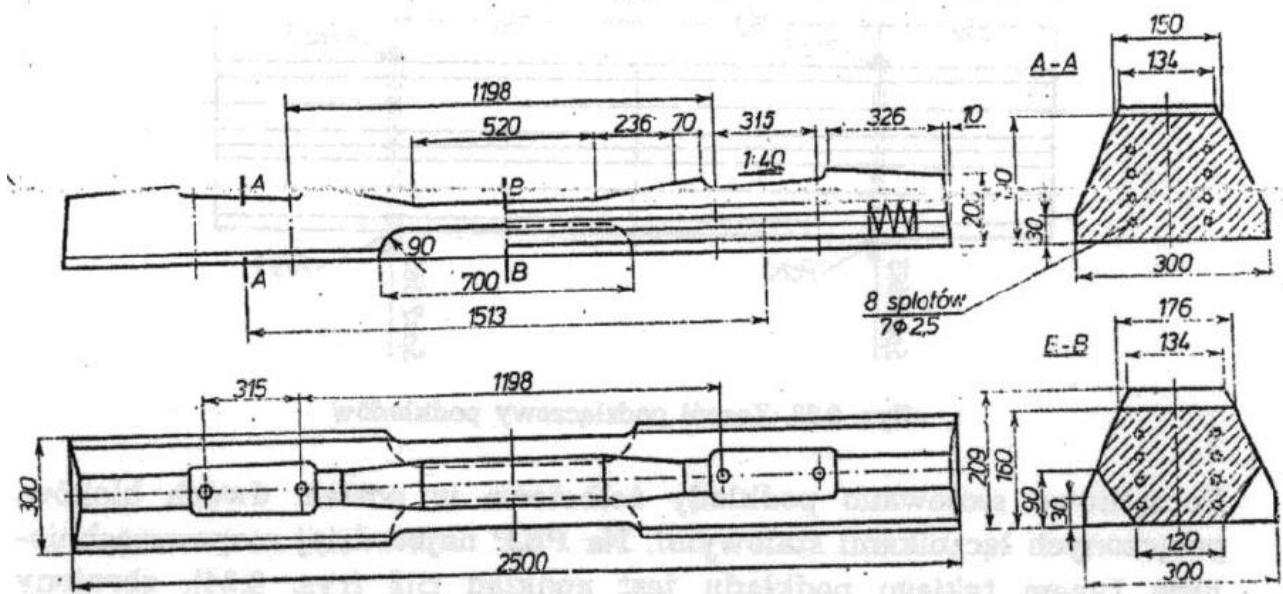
Podkład strunobetonowy typu INBK-7 przystosowany do przytwierdzenia klasycznego K.
